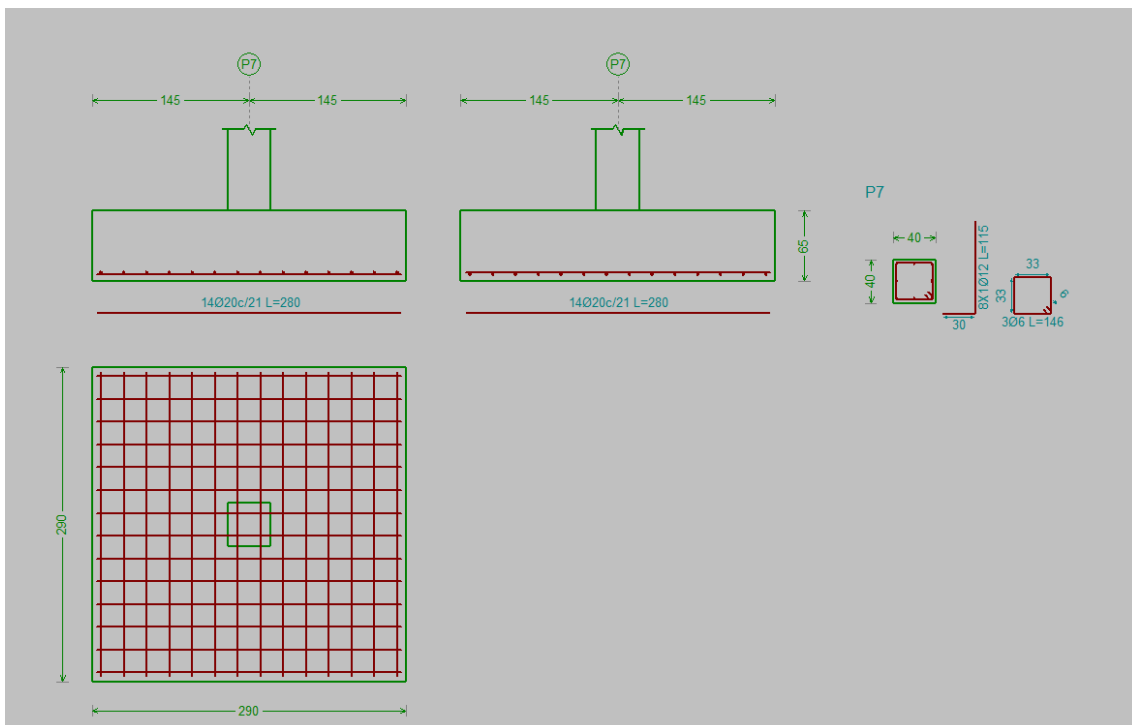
Geometría y armado de la zapata aislada bajo pilar P7
